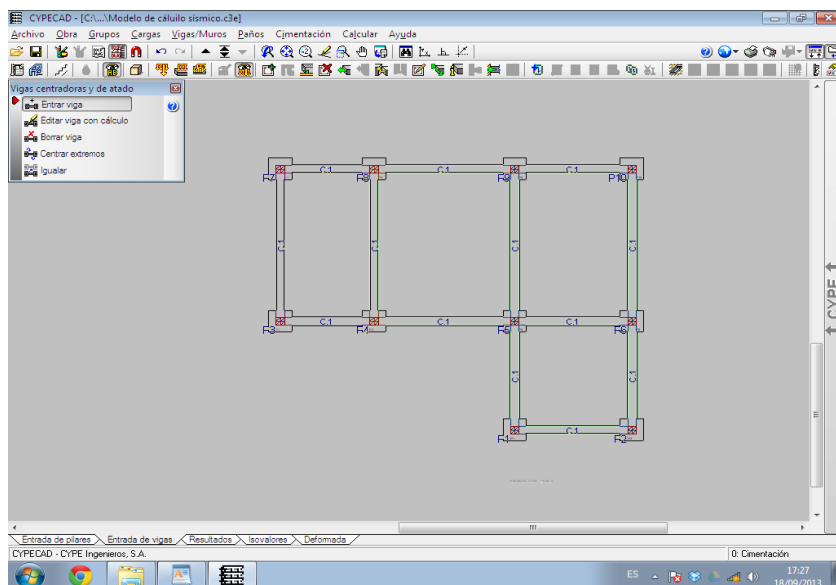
Planta baja del ejemplo de cálculo. Cimentación (zapatas y correas de atado).
